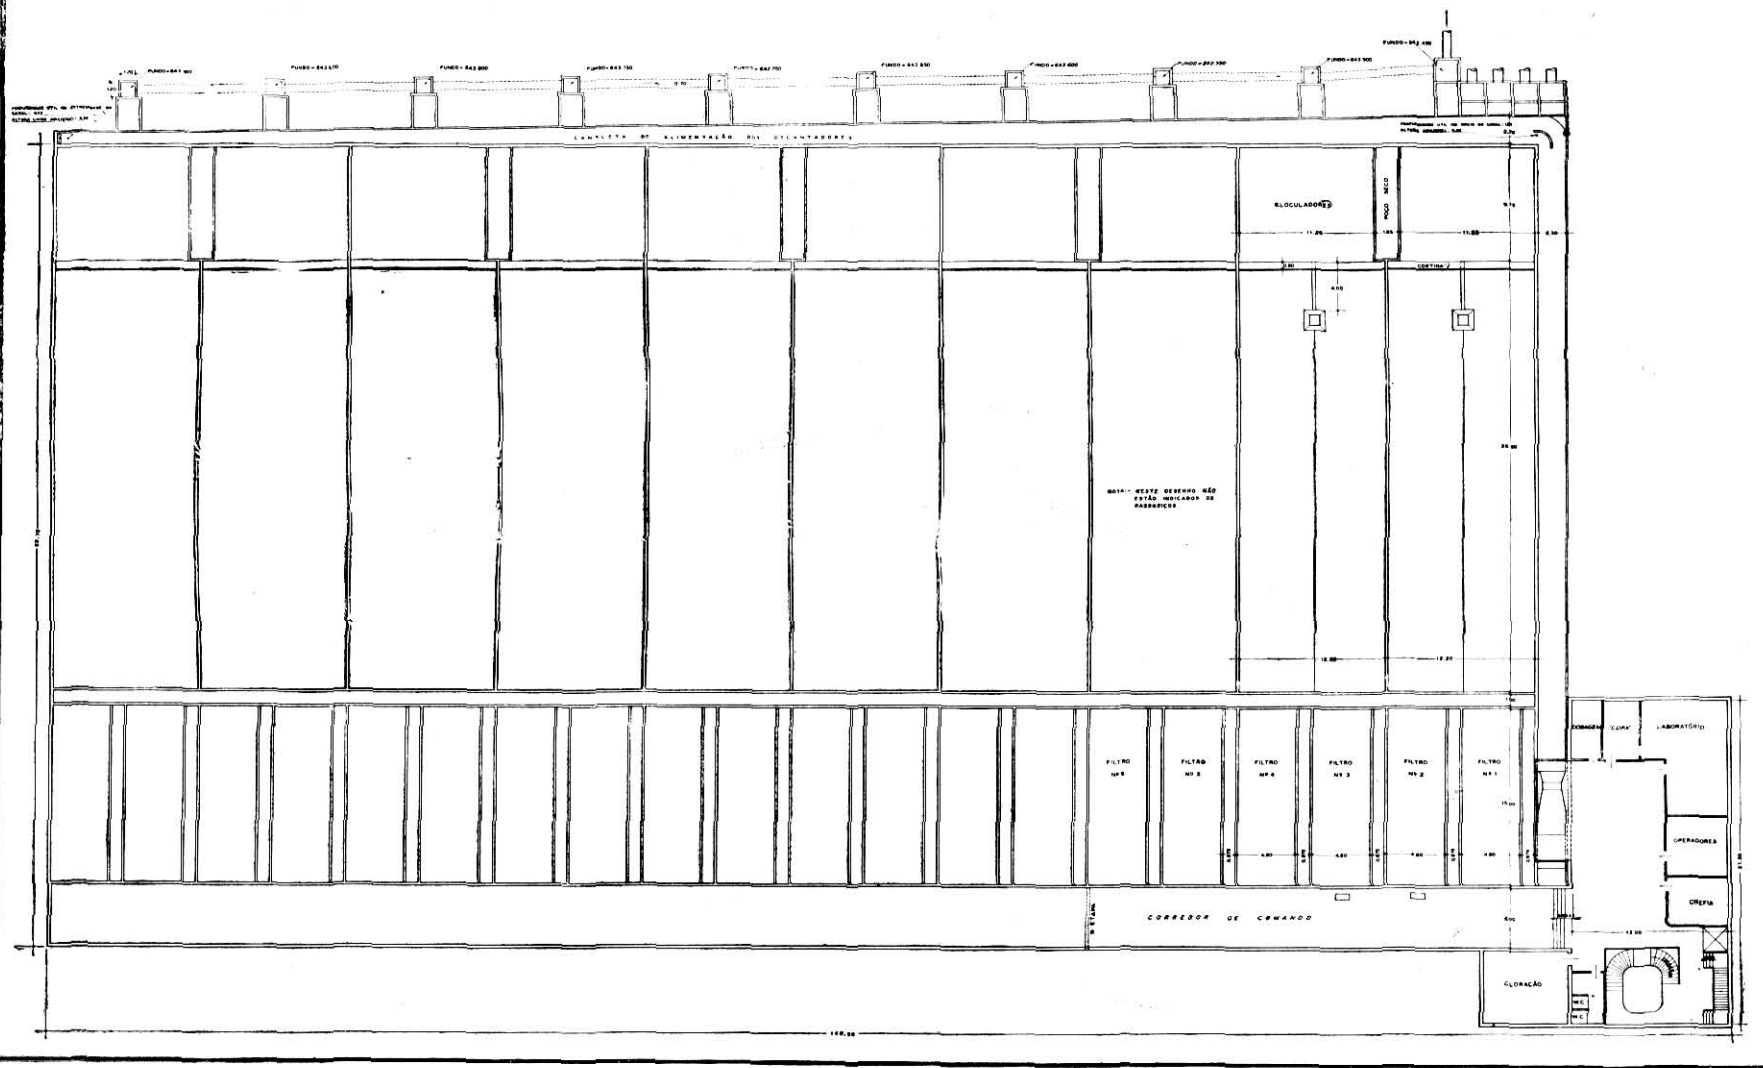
Planta geral (Nota: as cotas e alguns detalhes construtivos foram alterados durante a execução).
